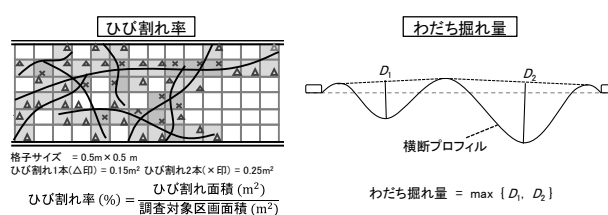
ひび割れ率とわだち掘れ量の算出
